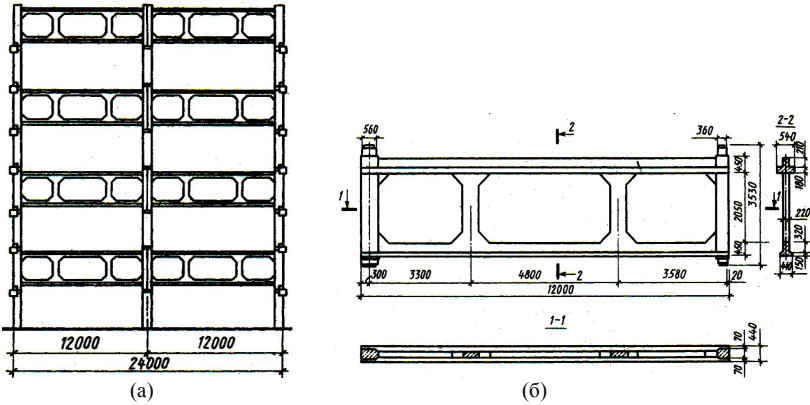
Багатоповерхова будівля з технічними поверхами: (а) – схема розрізу; (б) – креслення збірної залізобетонної безрозкісної ферми
